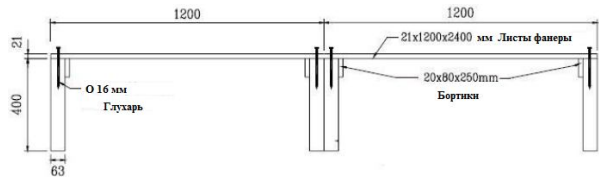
Поперечное сечение М-образной панели / The cross section of the M-shaped panel
